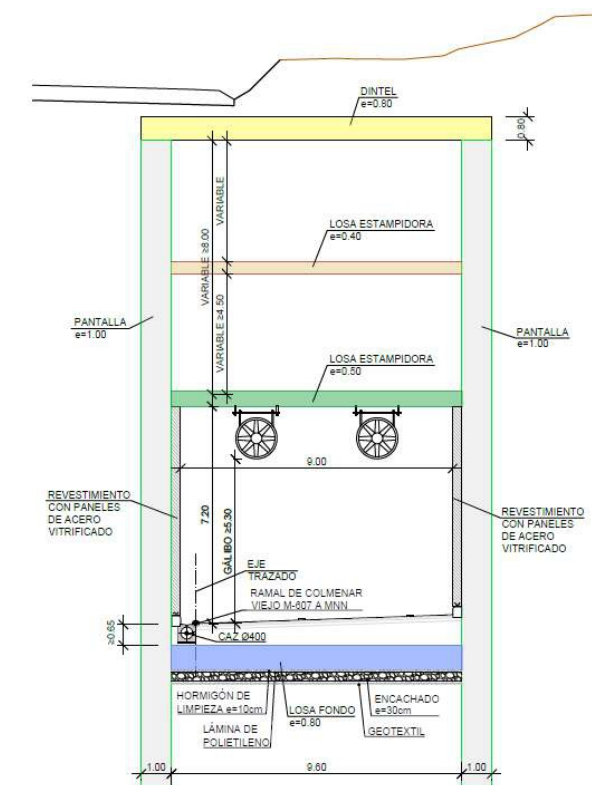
Sección tipo con losa de fondo de 0.80 m, estampidores intermedios y dintel macizo de 0.80 m. Falso túnel Sur (1A, 2A y 3A)
